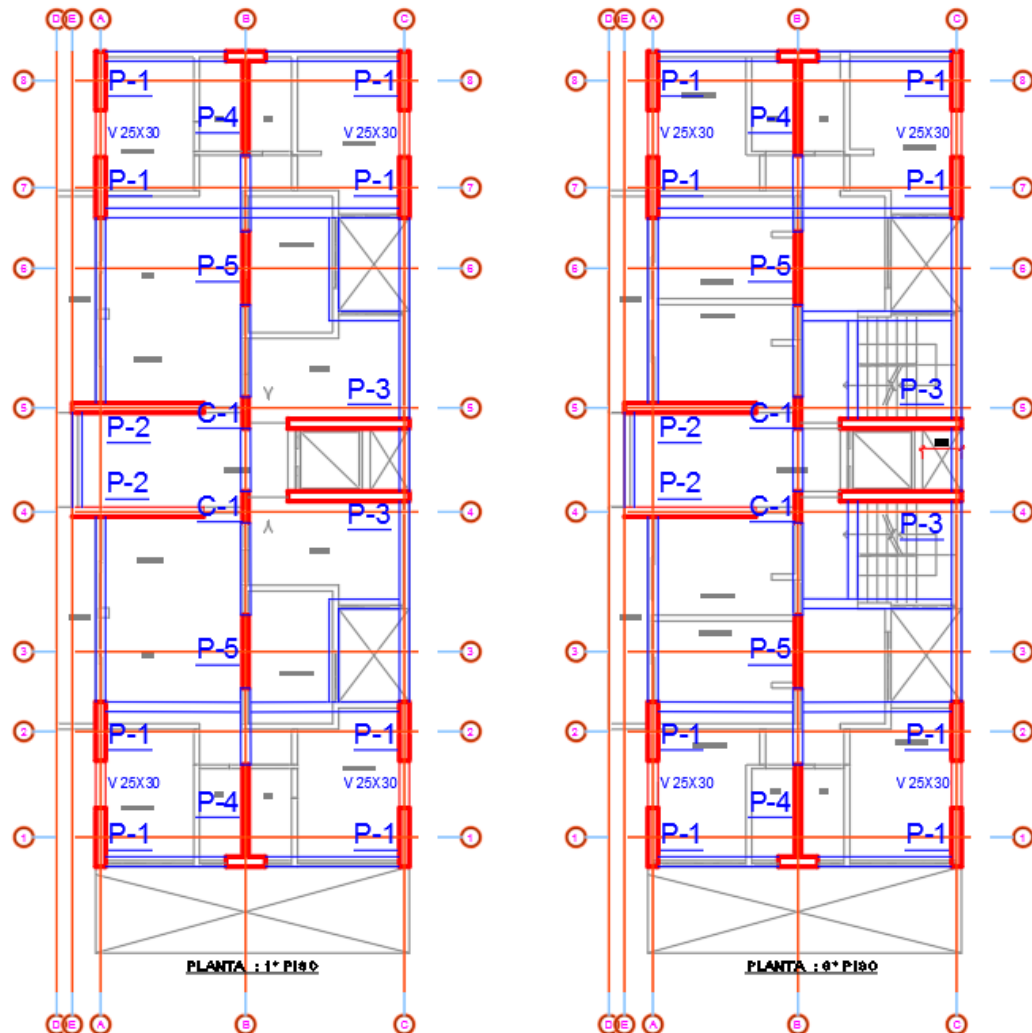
Primera propuesta de multifamiliar (Elaboración propia)
